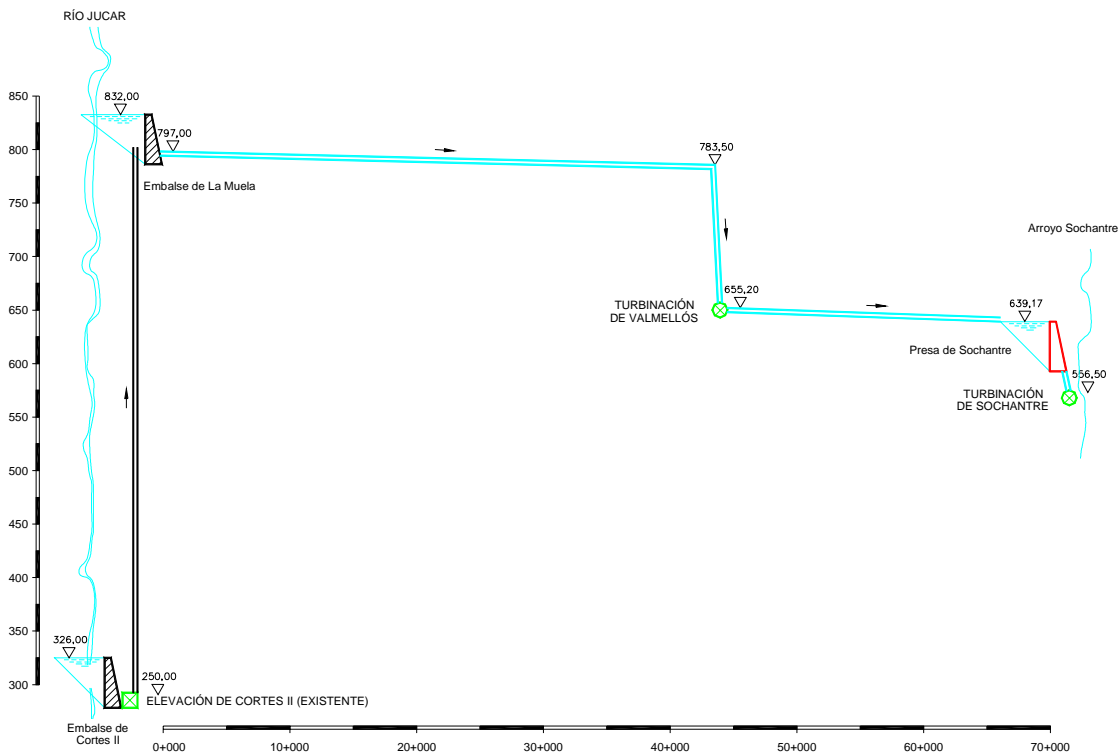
Conducción La Muela - Villena. Esquema en alzado
